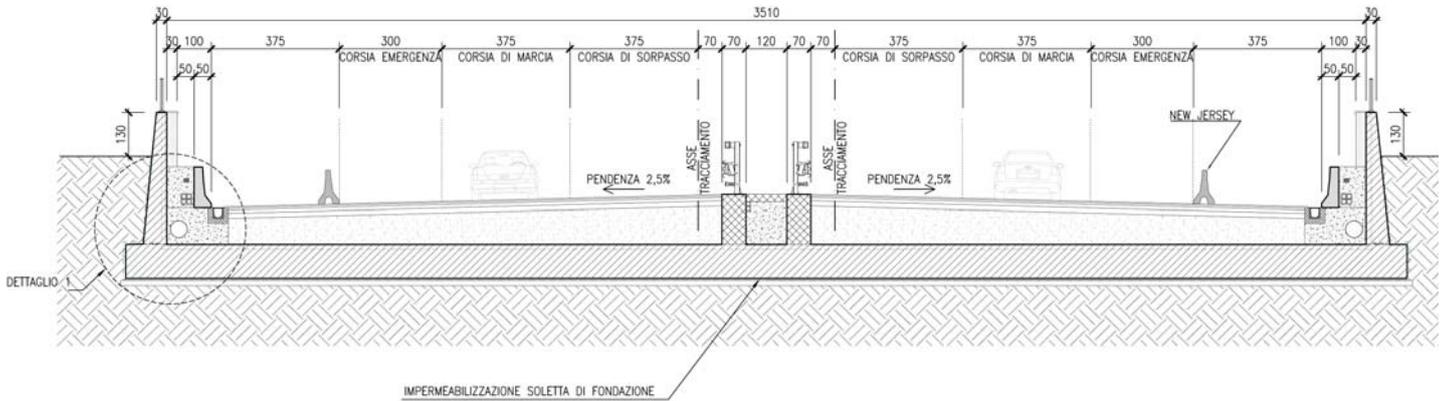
SEZIONE TIPICA TRINCEA 1.
